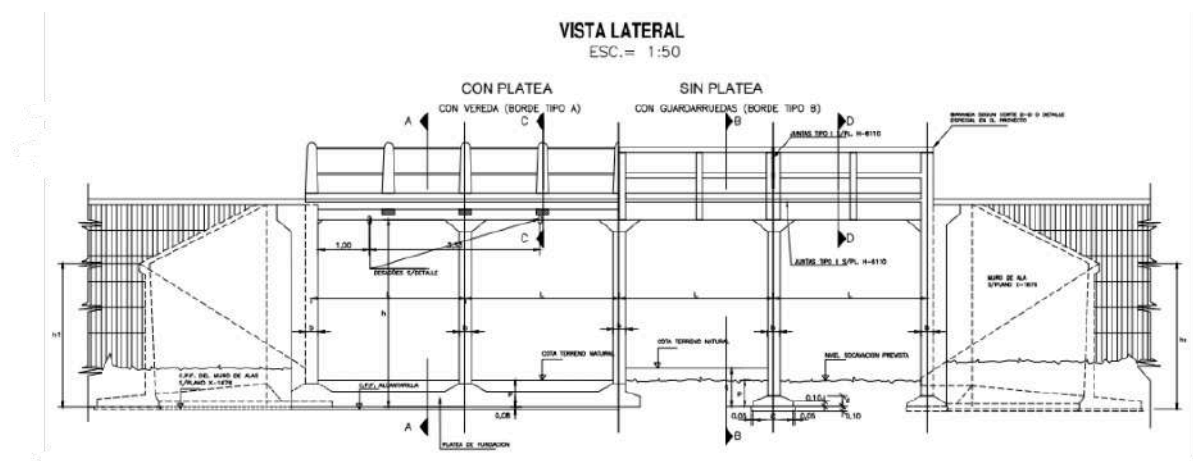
Alcantarilla puente y fundación con pilotes, vista lateral.
